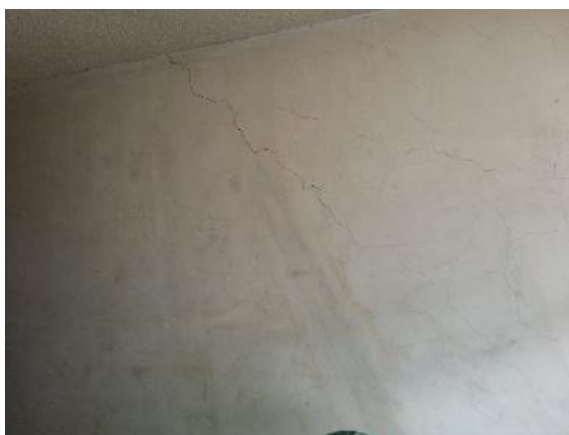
Grietas diagonales en paredes en una vivienda.
